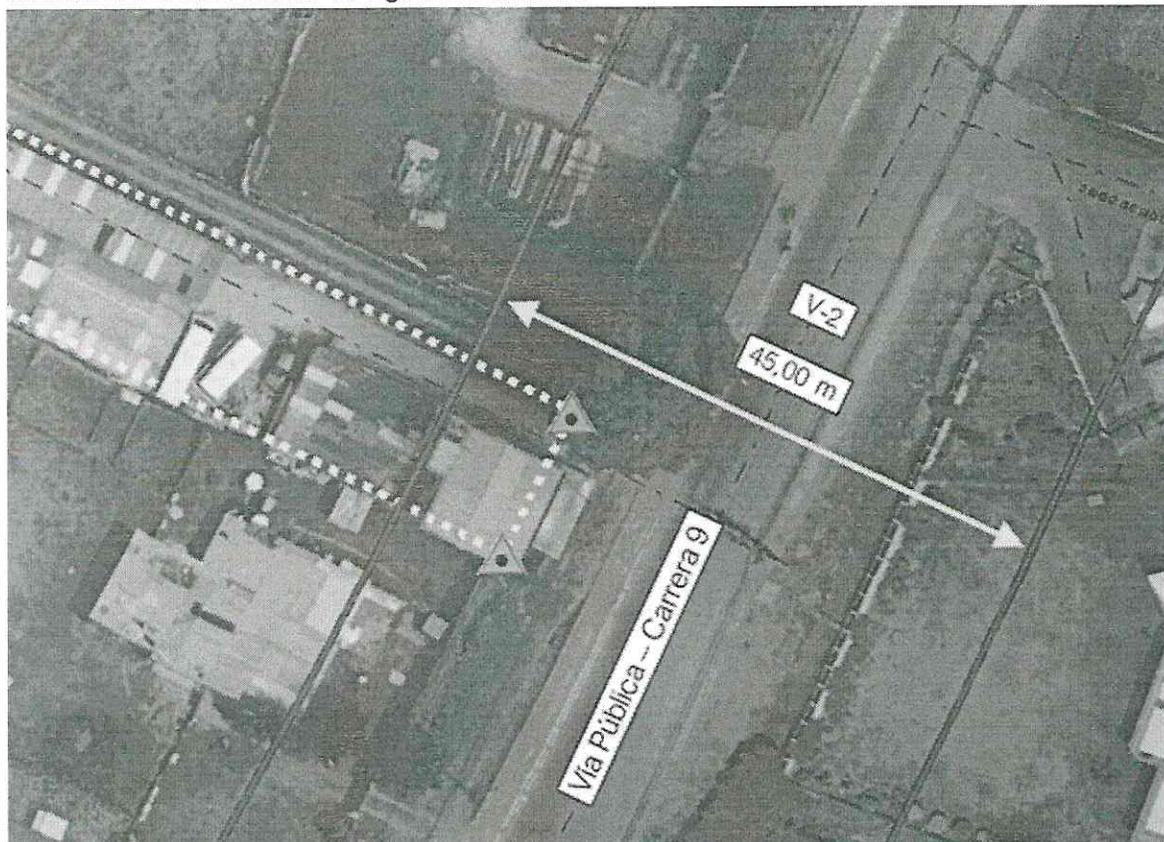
Trazado perfil proyectado para la zona CARRERA 9.
